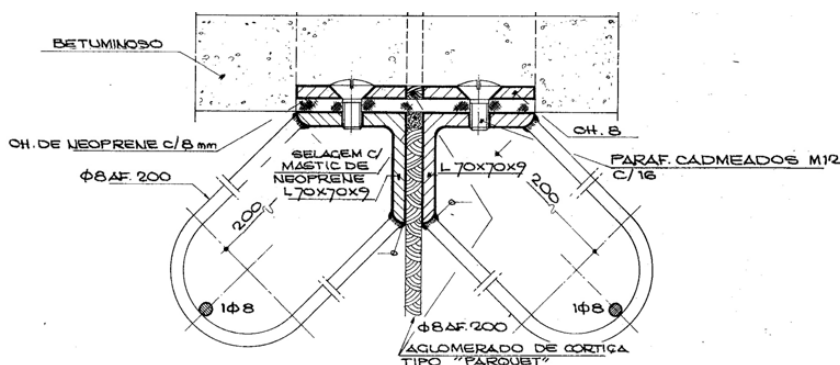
Pormenorização de projeto de uma junta oculta sob pavimento (fonte: (Rito, A., 1983))
